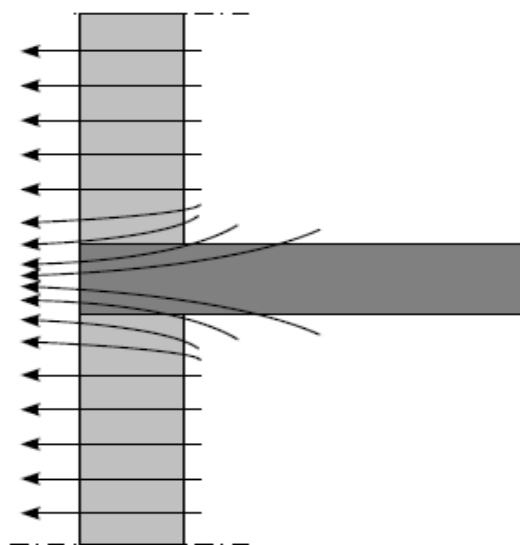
Ponte térmica na ligação da laje com a fachada
